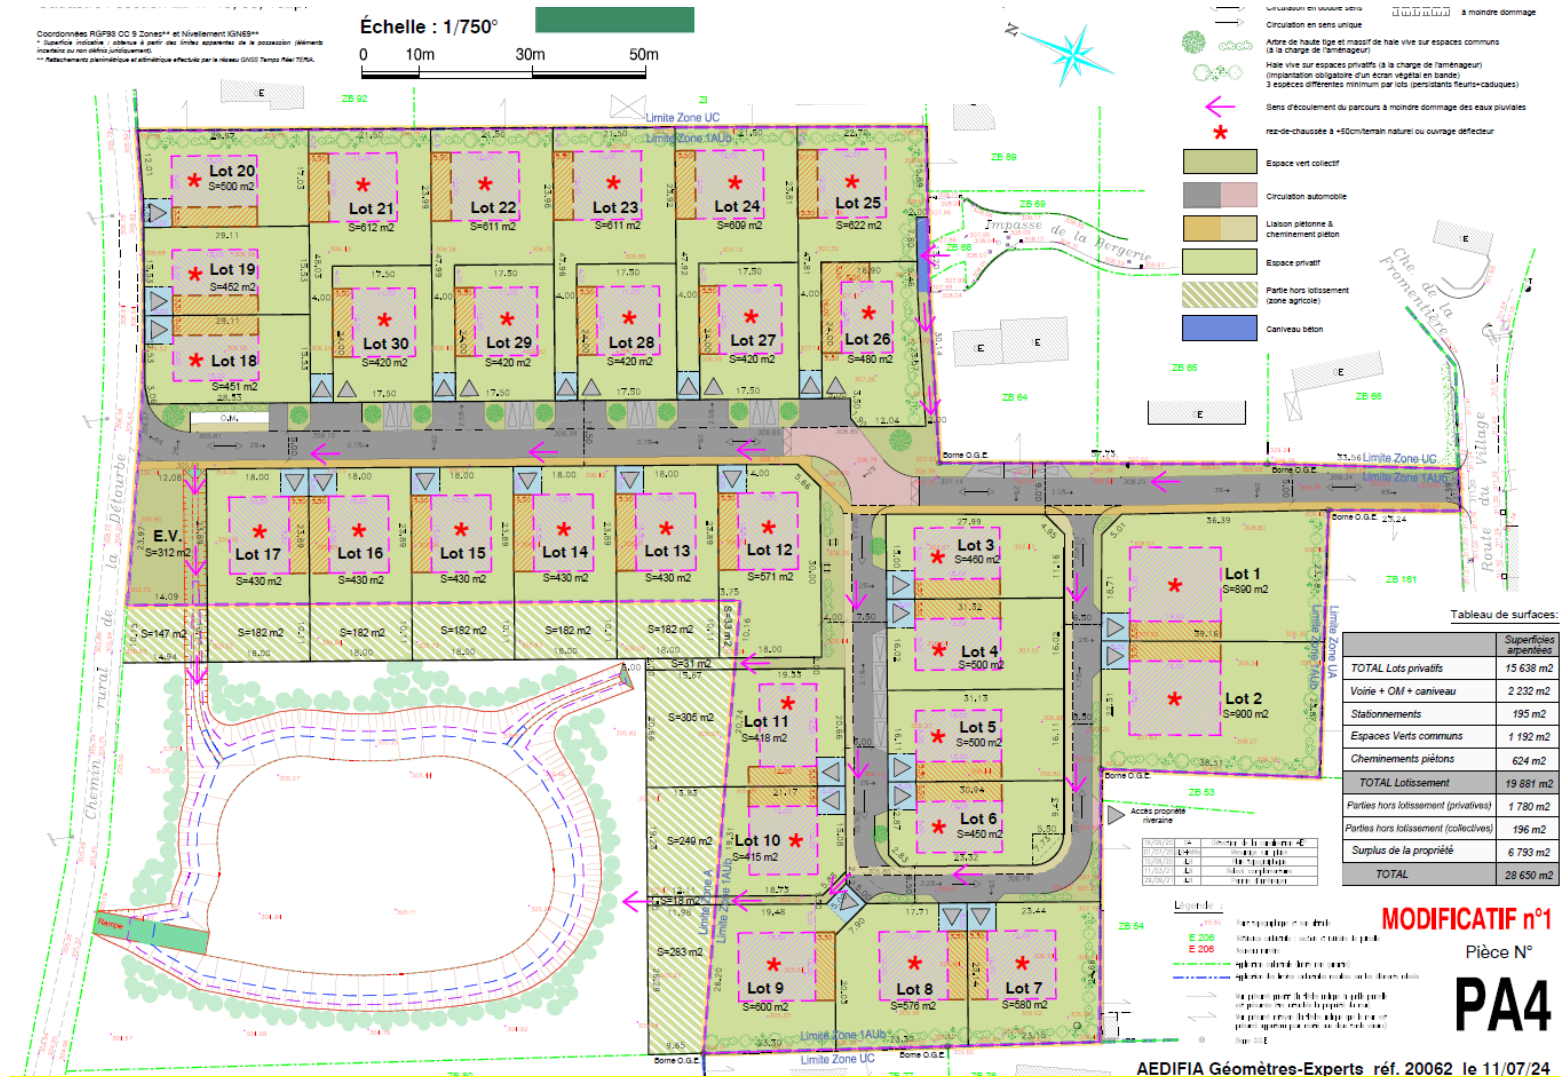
Plan masse de lotissement (Source : AEDIFIA)
